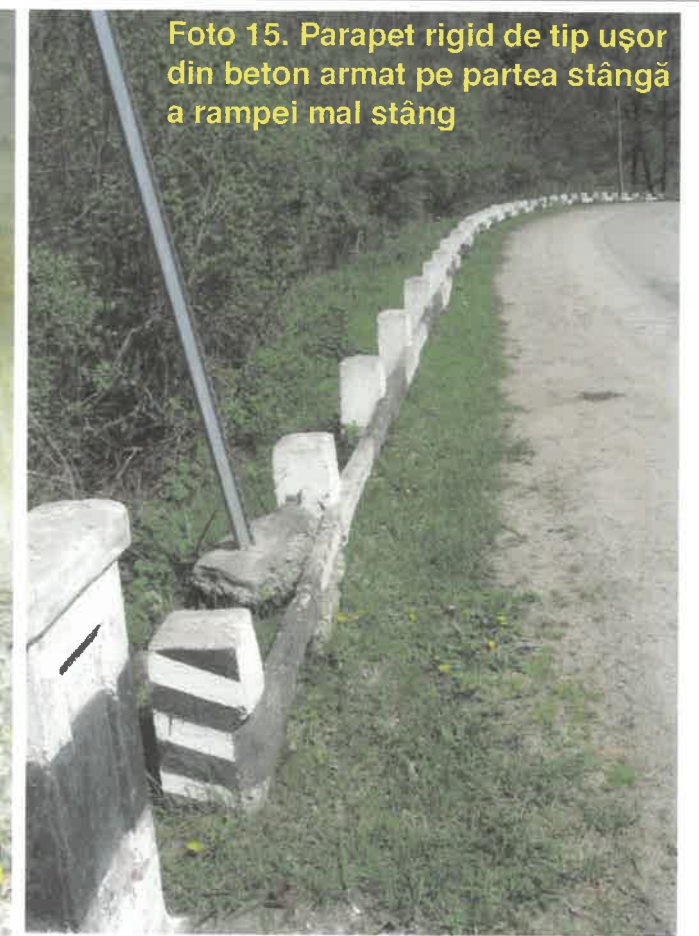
Parapet rigid de tip ușor din beton armat pe partea stângă a rampei mal stâng
